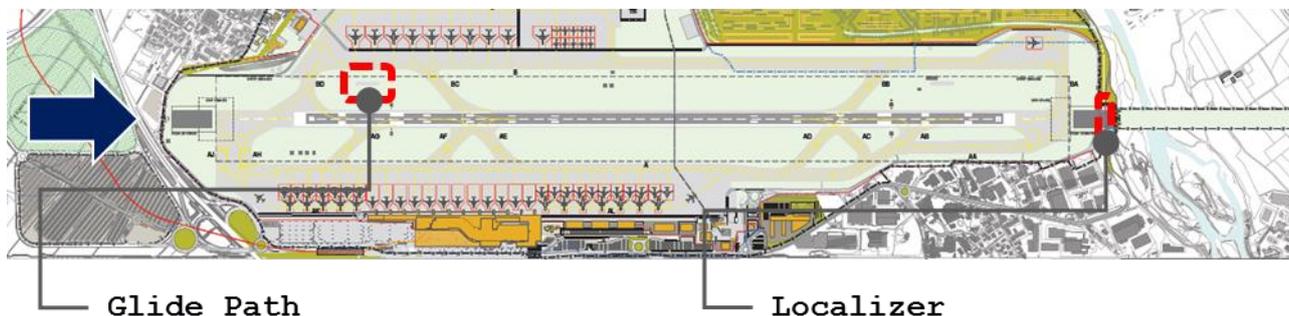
Intervento E1: Sistema ILS pista 10, localizzazione ed esemplificazione della soluzione di progetto individuata dal PSA
